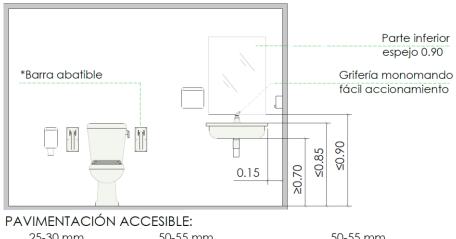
Baños accesibles para trabajadores en Planta - 1. Fuente: Elaboración propia.
